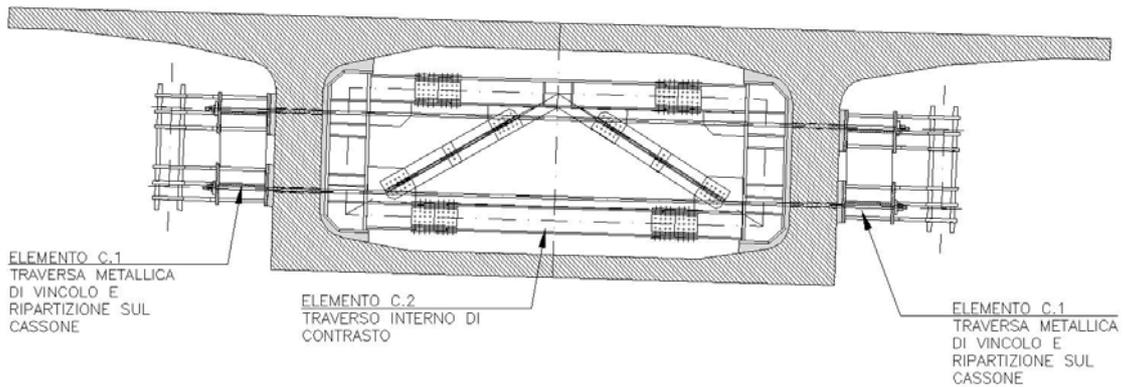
Spalla Sp.1 - Sezione trasversale in asse fissaggio su cassone
